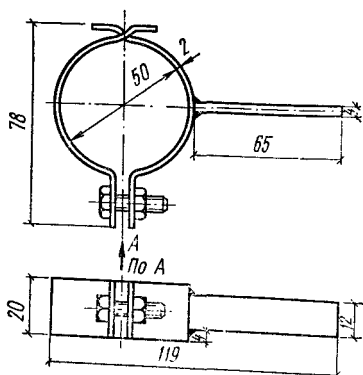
Хомуты типа 41кс (масса 0,18 кг) для крепления полиэтиленовых труб  $D_y$  50 мм к закладным деталям сваркой в санитарно-технических кабин
